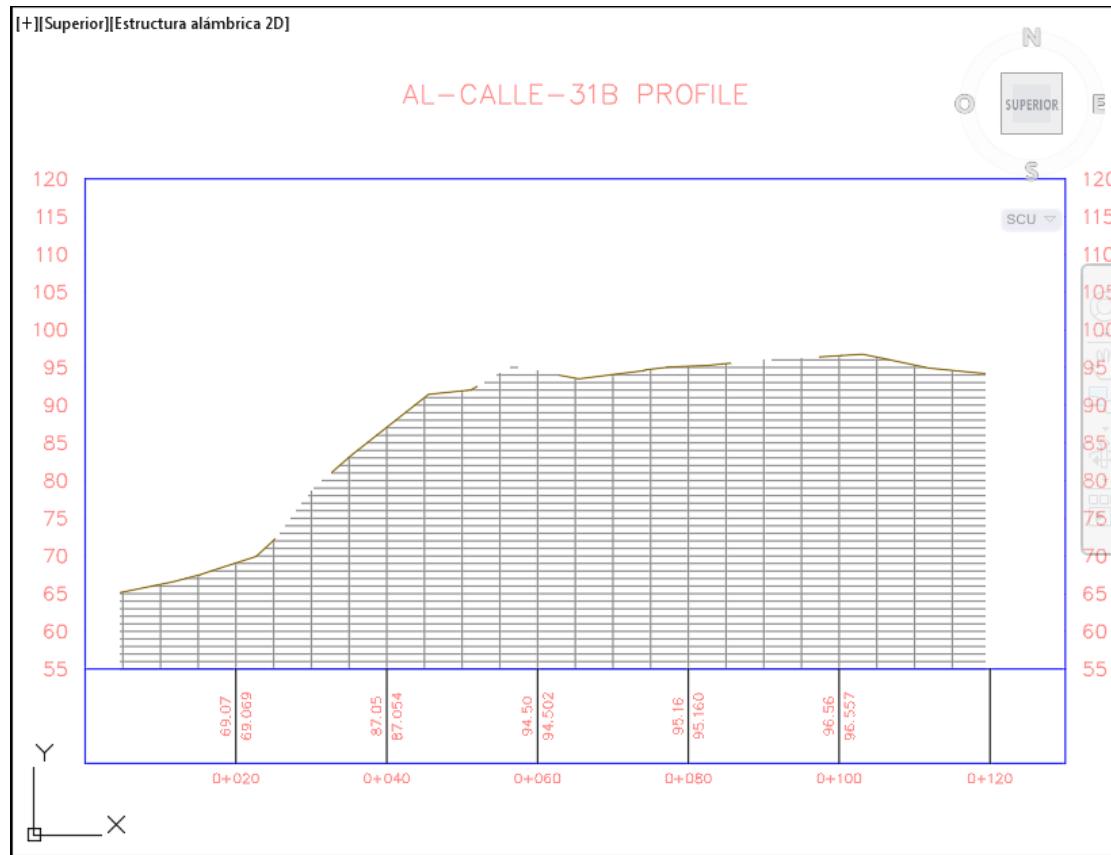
Perfil topográfico suministrado de la sección Calle 31 B
